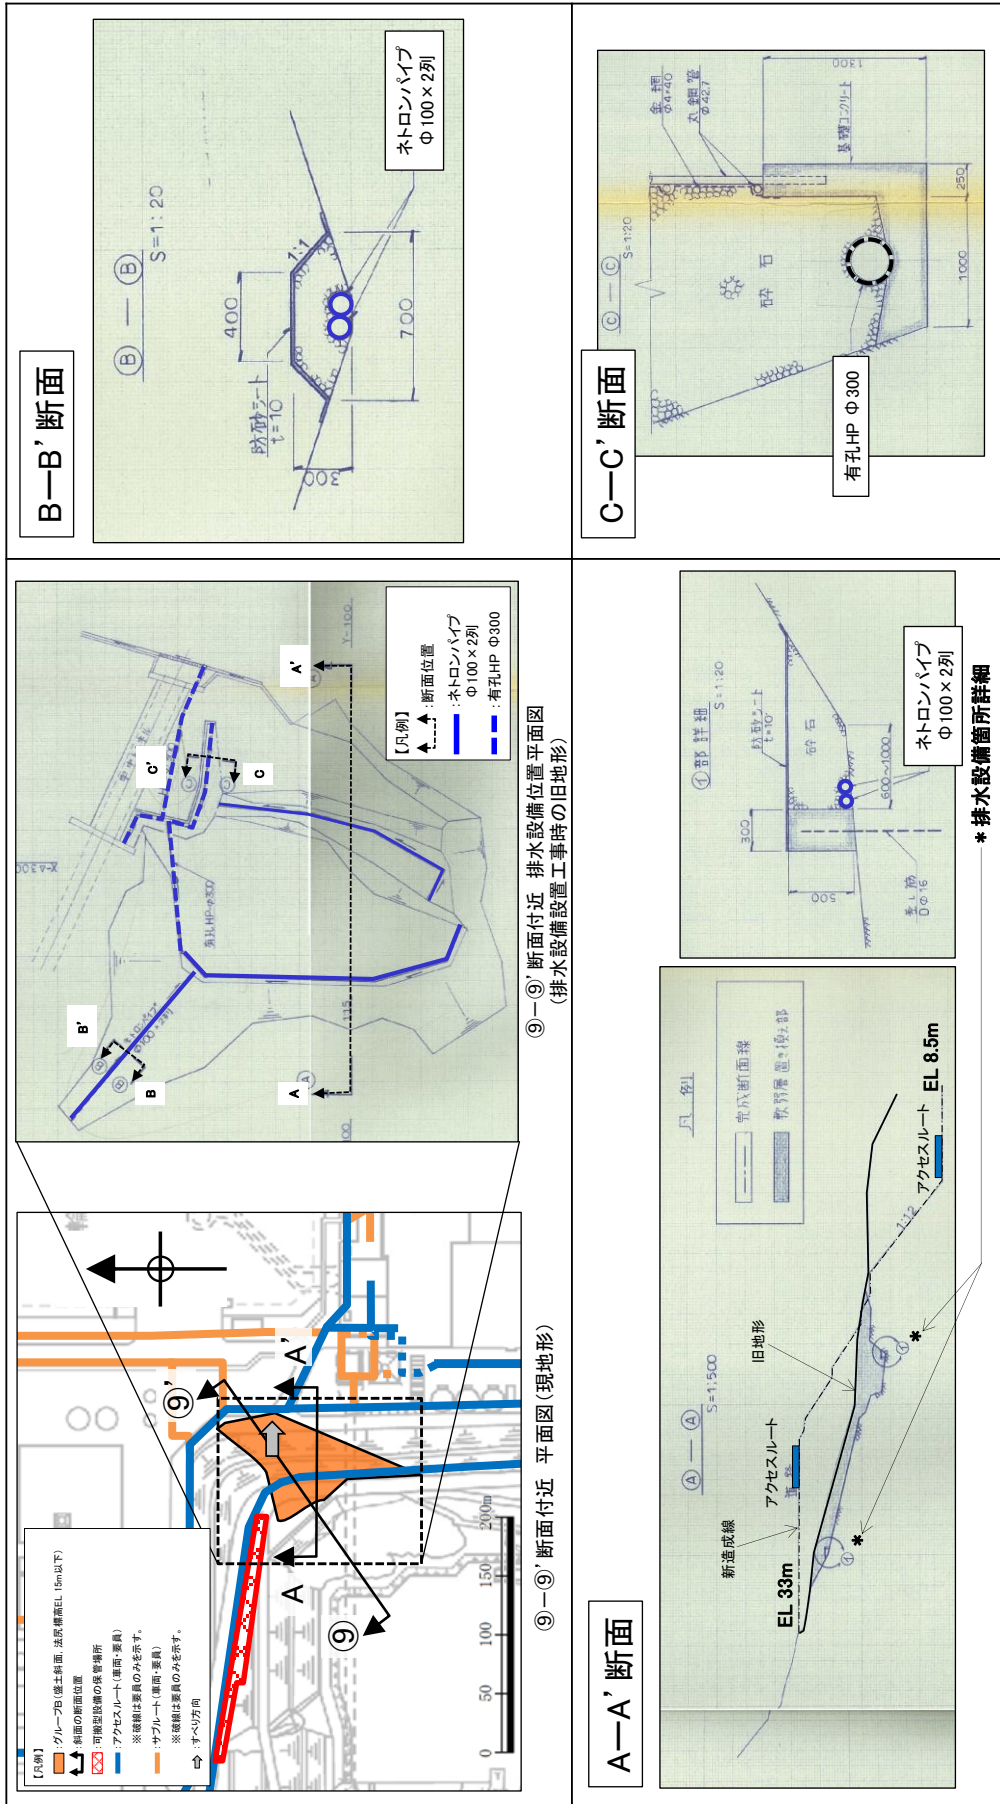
排水設備設置位置 (⑨-⑨' 断面付近)
